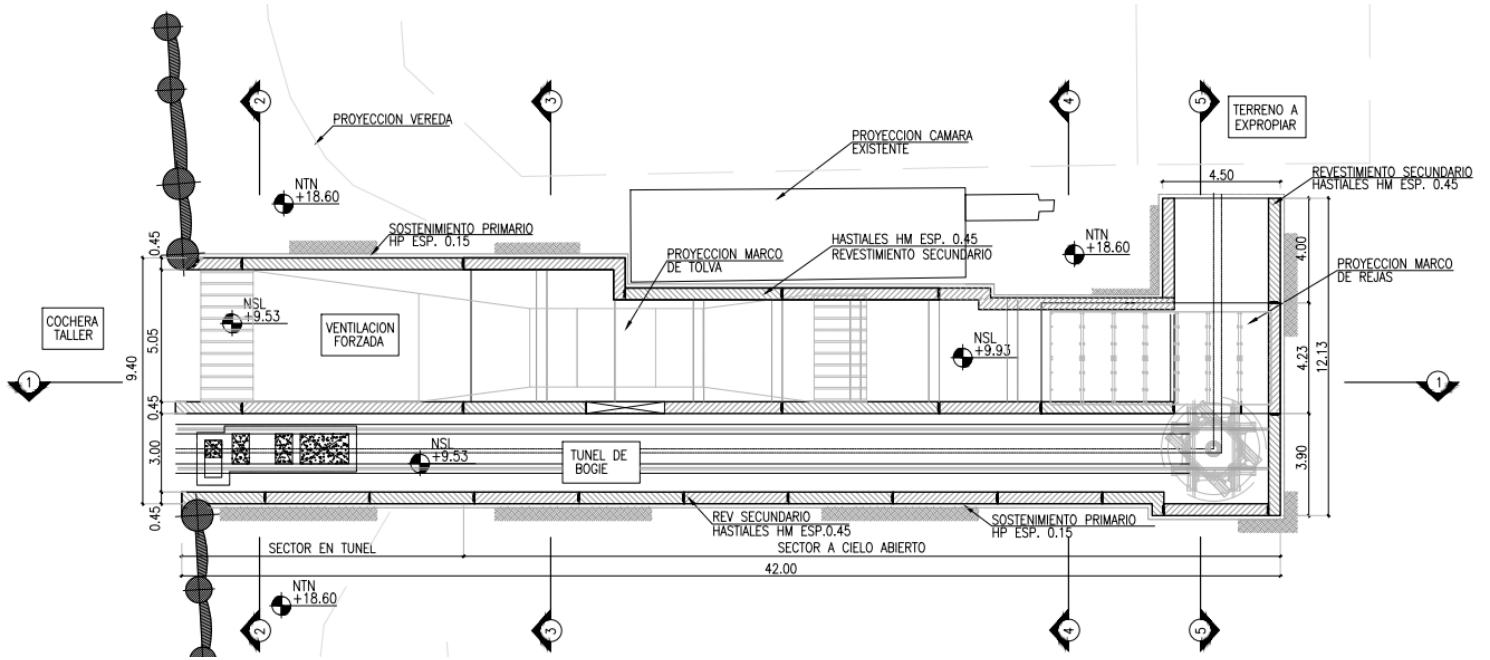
Planta de la sala de ventilación y el túnel de bogies.
